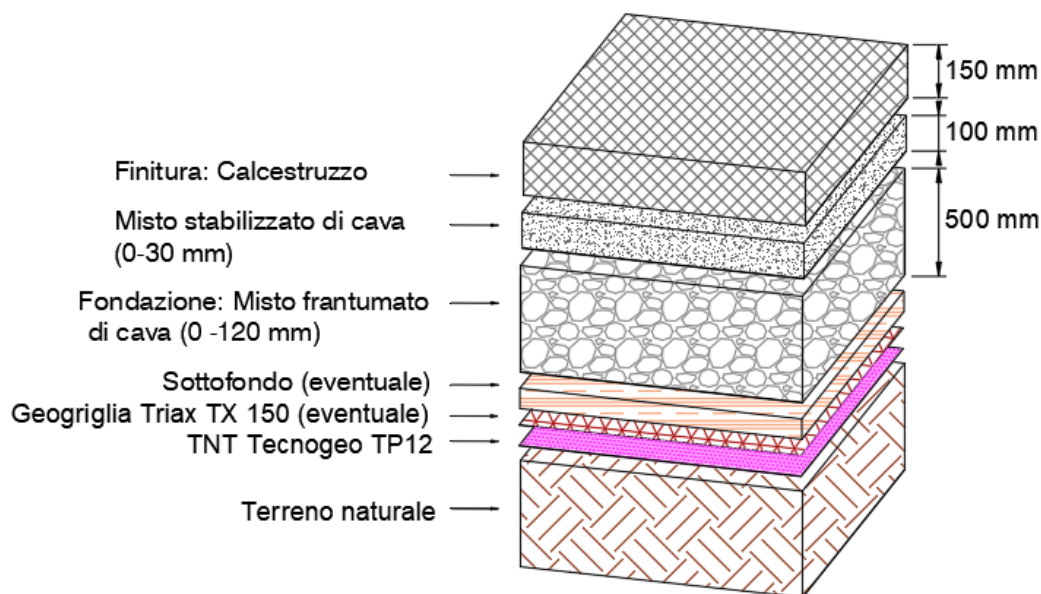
Tipico pacchetto stradale di Progetto – tratti a forte pendenza
